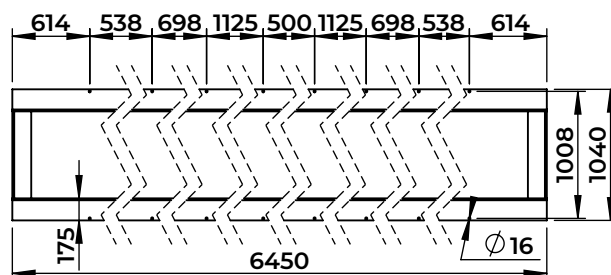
Dimensions et positions de montage pour une fondation en acier structurel
